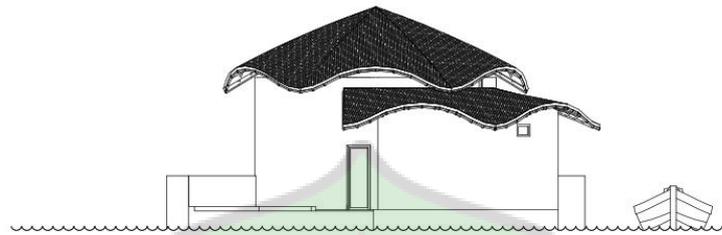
Tampak Belakang Bangunan Lobby dan Pengelola
